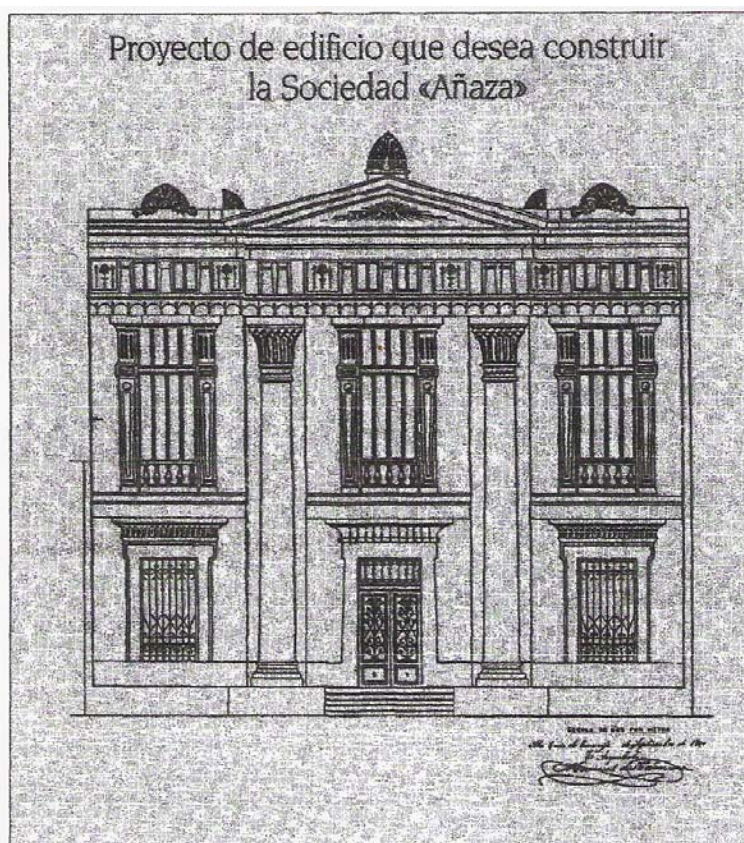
Planos de Fachada correspondiente al proyecto original de 1900.
